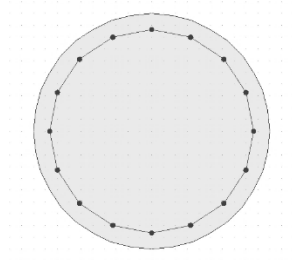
Geometria della sezione caratteristica delle pile con armature longitudinali
